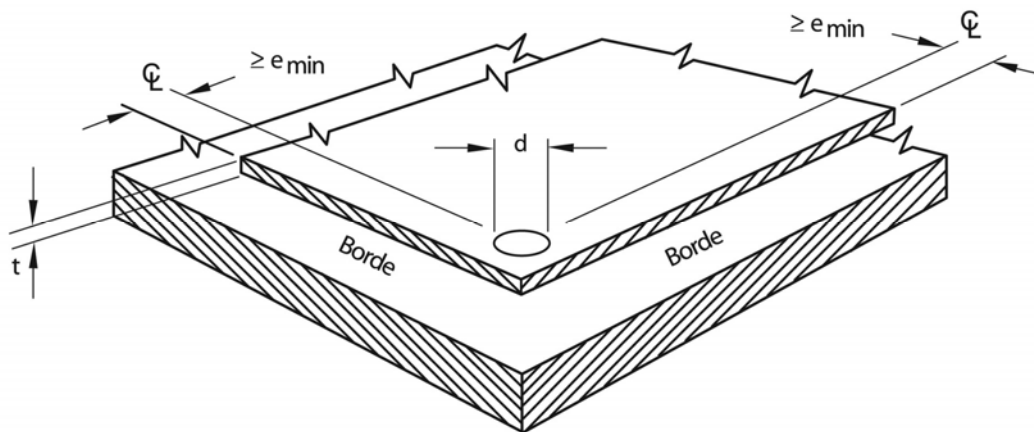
Distancia al borde para soldaduras de tapón — lámina sencilla
